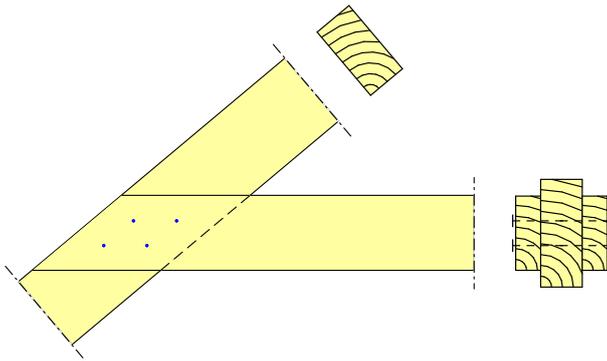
Anschlussdetail zweiteiliger Kehlbalken an Sparren
